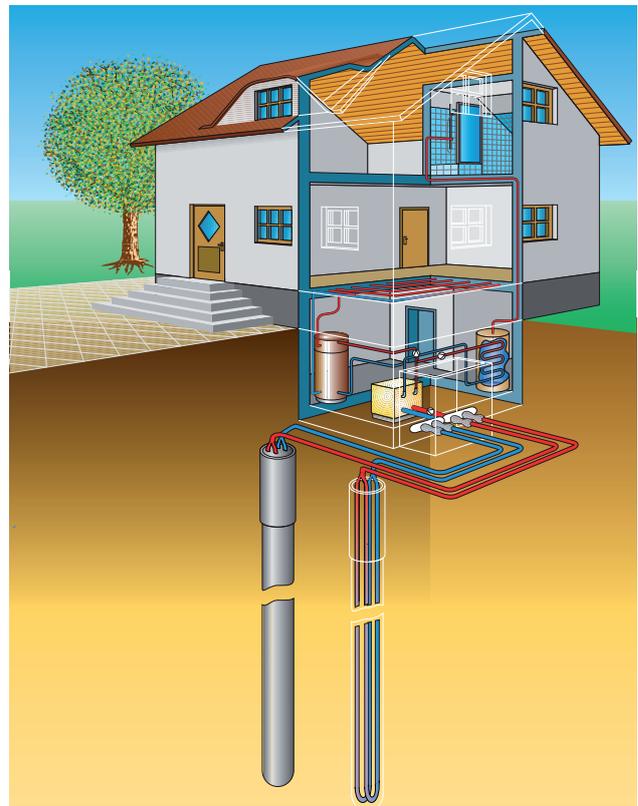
Erdreich Wärmepumpe mit Sondenanlage
